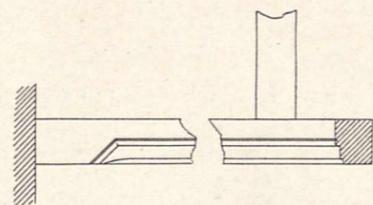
Kaminbalken im Erdgeschoß des Wohnflügels. 1:40.
